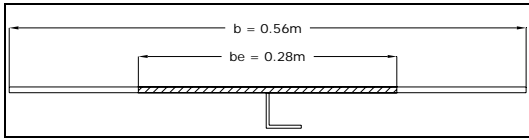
Ancho efectivo calculado para el refuerzo longitudinal de fondo
